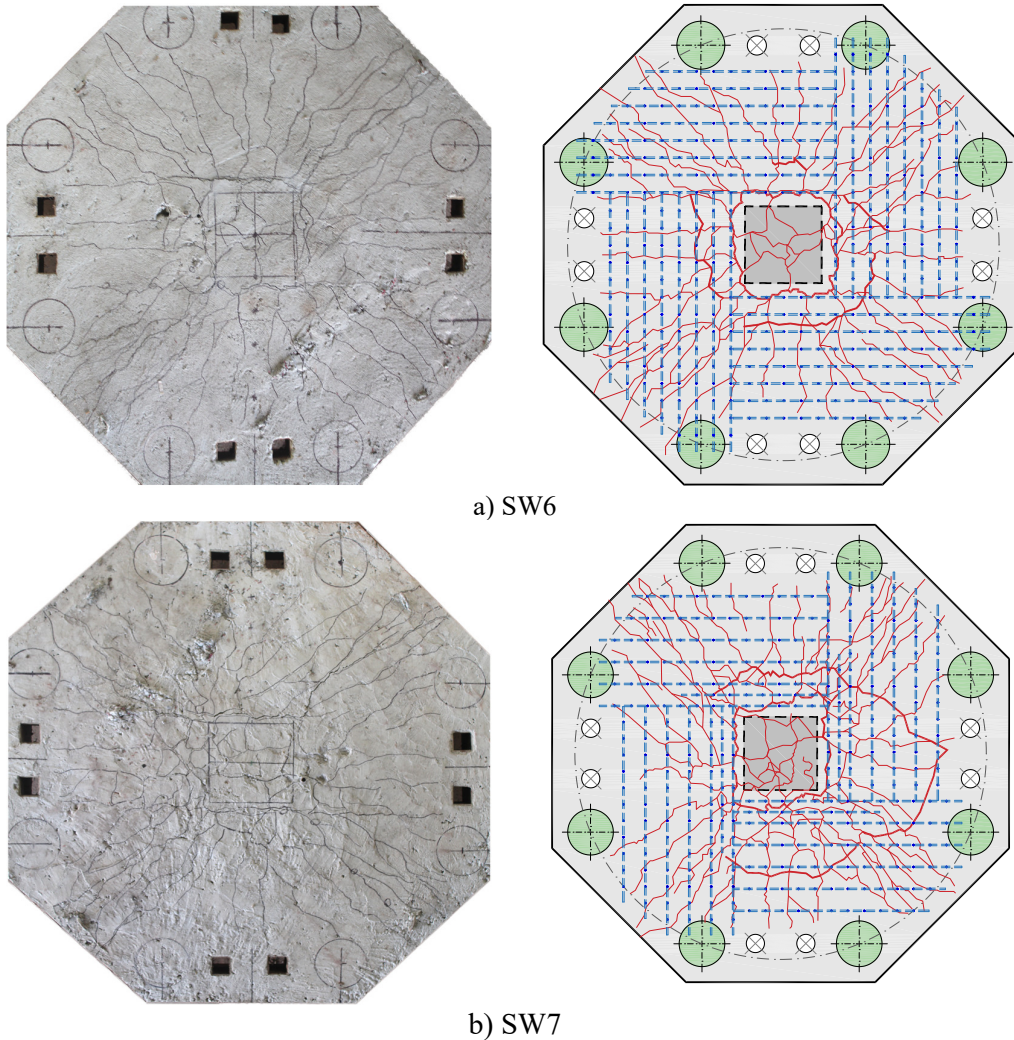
Mapa de fissuração das lajes SW6 e SW7.
